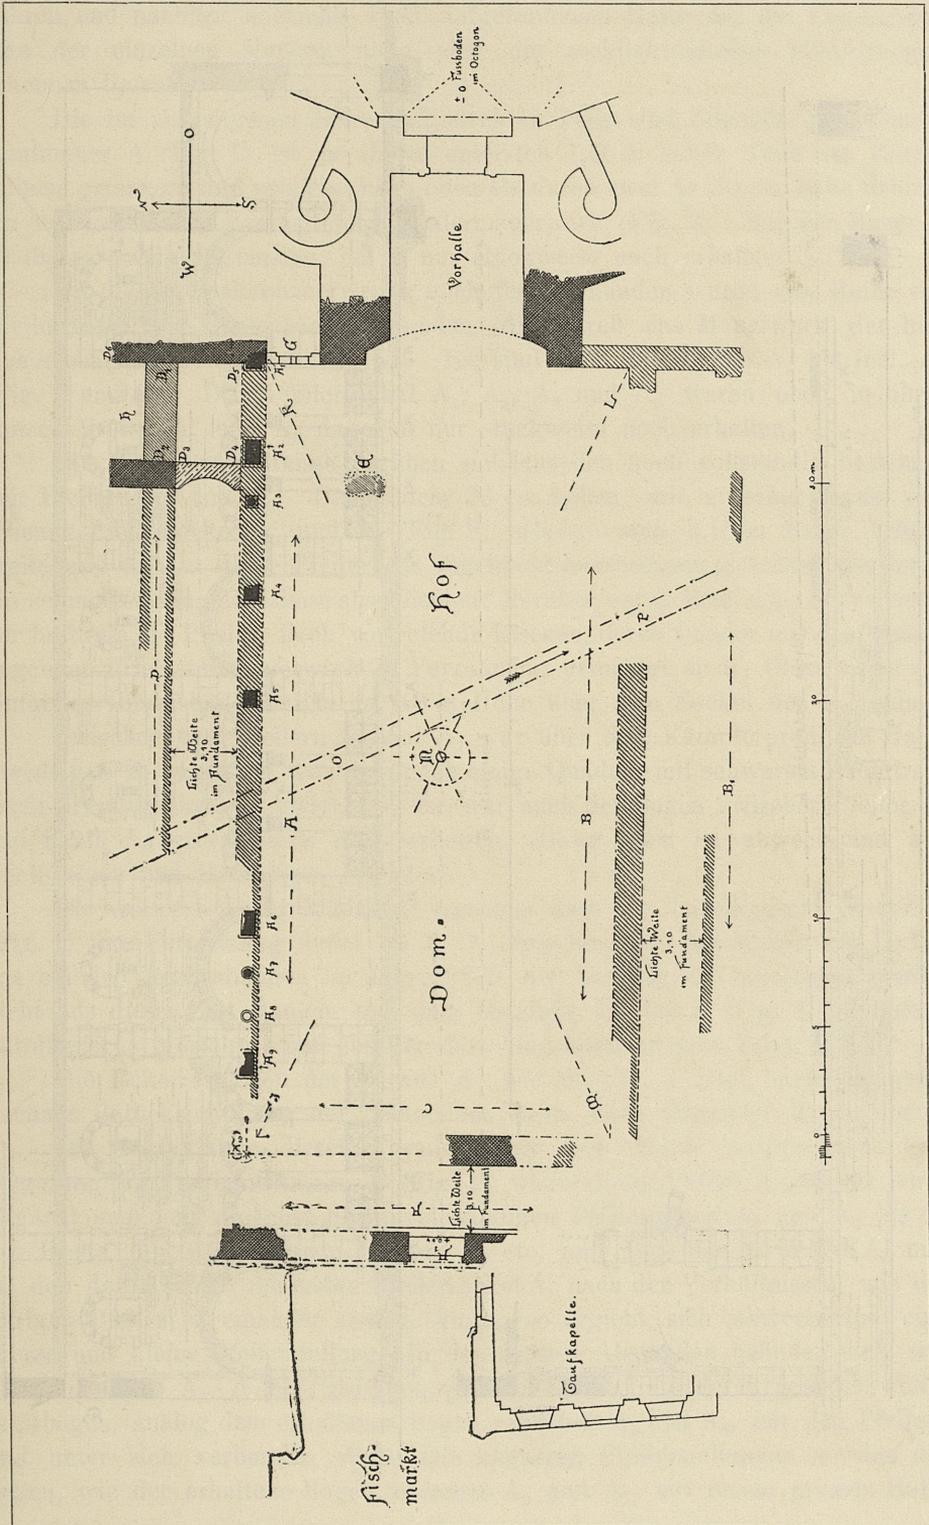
Grundriss des Atriums am Karolinger-Münster zu Aachen.
